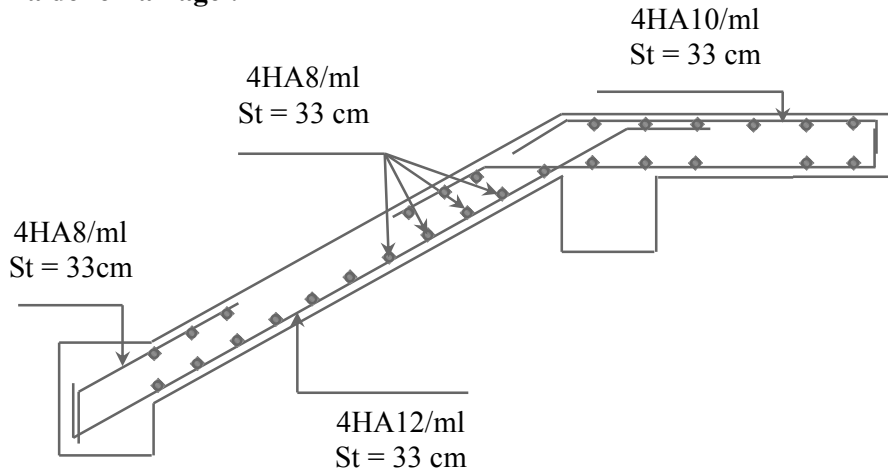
Schéma de ferrailage de l'escalier type (2), partie (AB).
